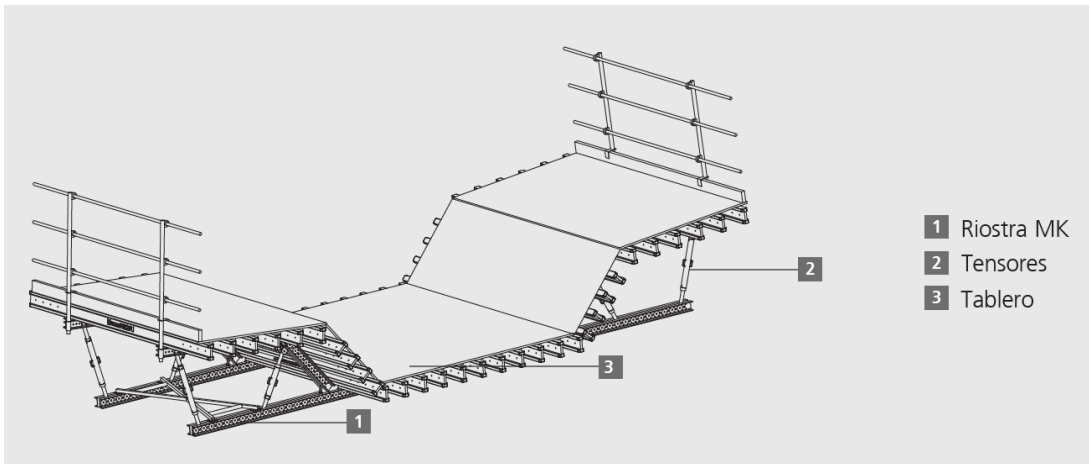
Encofrado exterior para viga cajón. Fuente [5]
